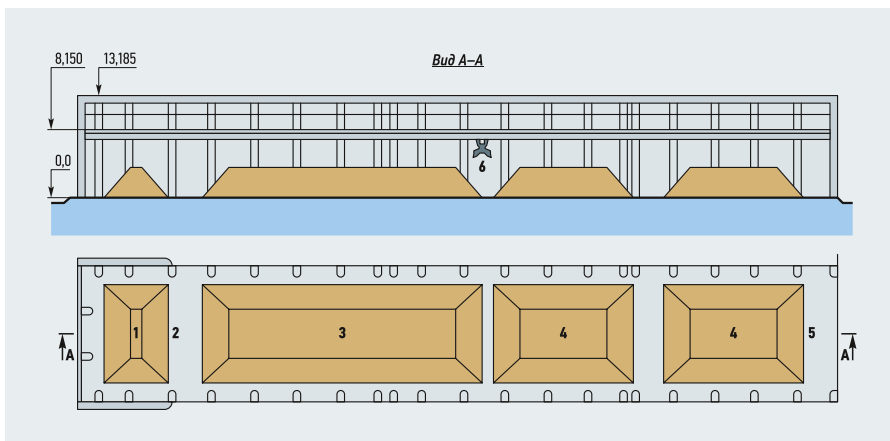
Площадка компостирования (1 — закрытая площадка для хранения посадочного материала; 2 — площадка для погрузки готового компоста; 3 — площадка дозревания; 4 — площадка компостирования; 5 — площадка смешения осадка с посадочным материалом; 6 — кран)
